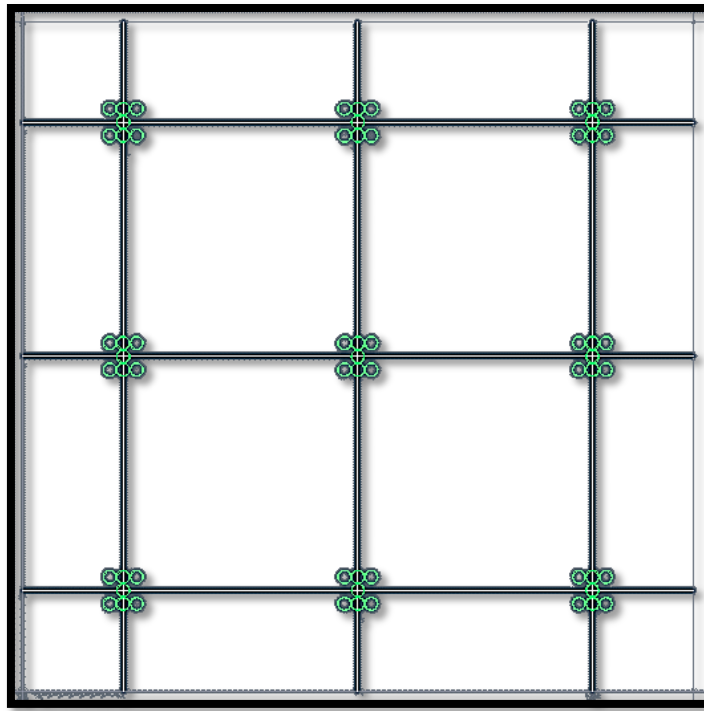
Tentativa de distribución de columnas de GaK. (Planta Baja)
